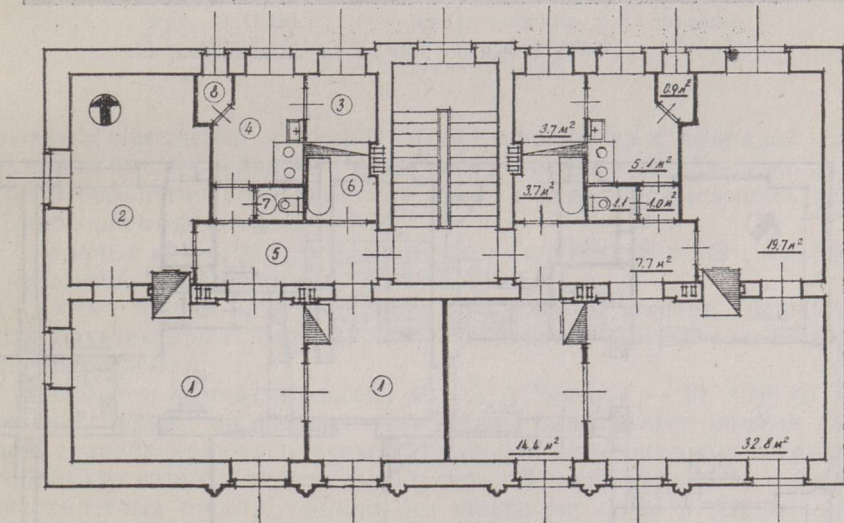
План типового этажа жилого дома по ул. Янсени, 3 (1923 г.):
